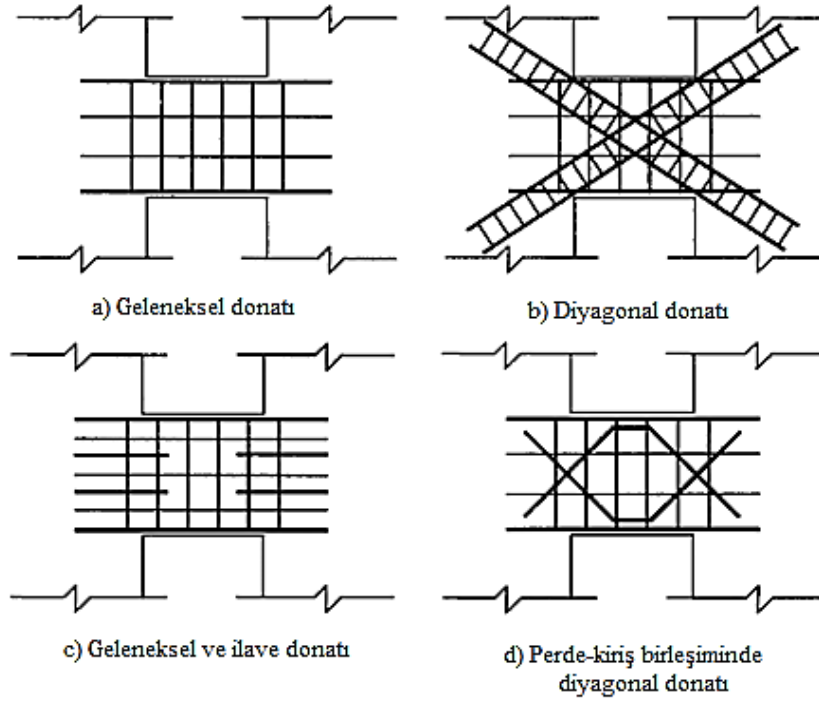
Galano ve Vignoli'ye ait bağ kirişi donatı detayları [103]
